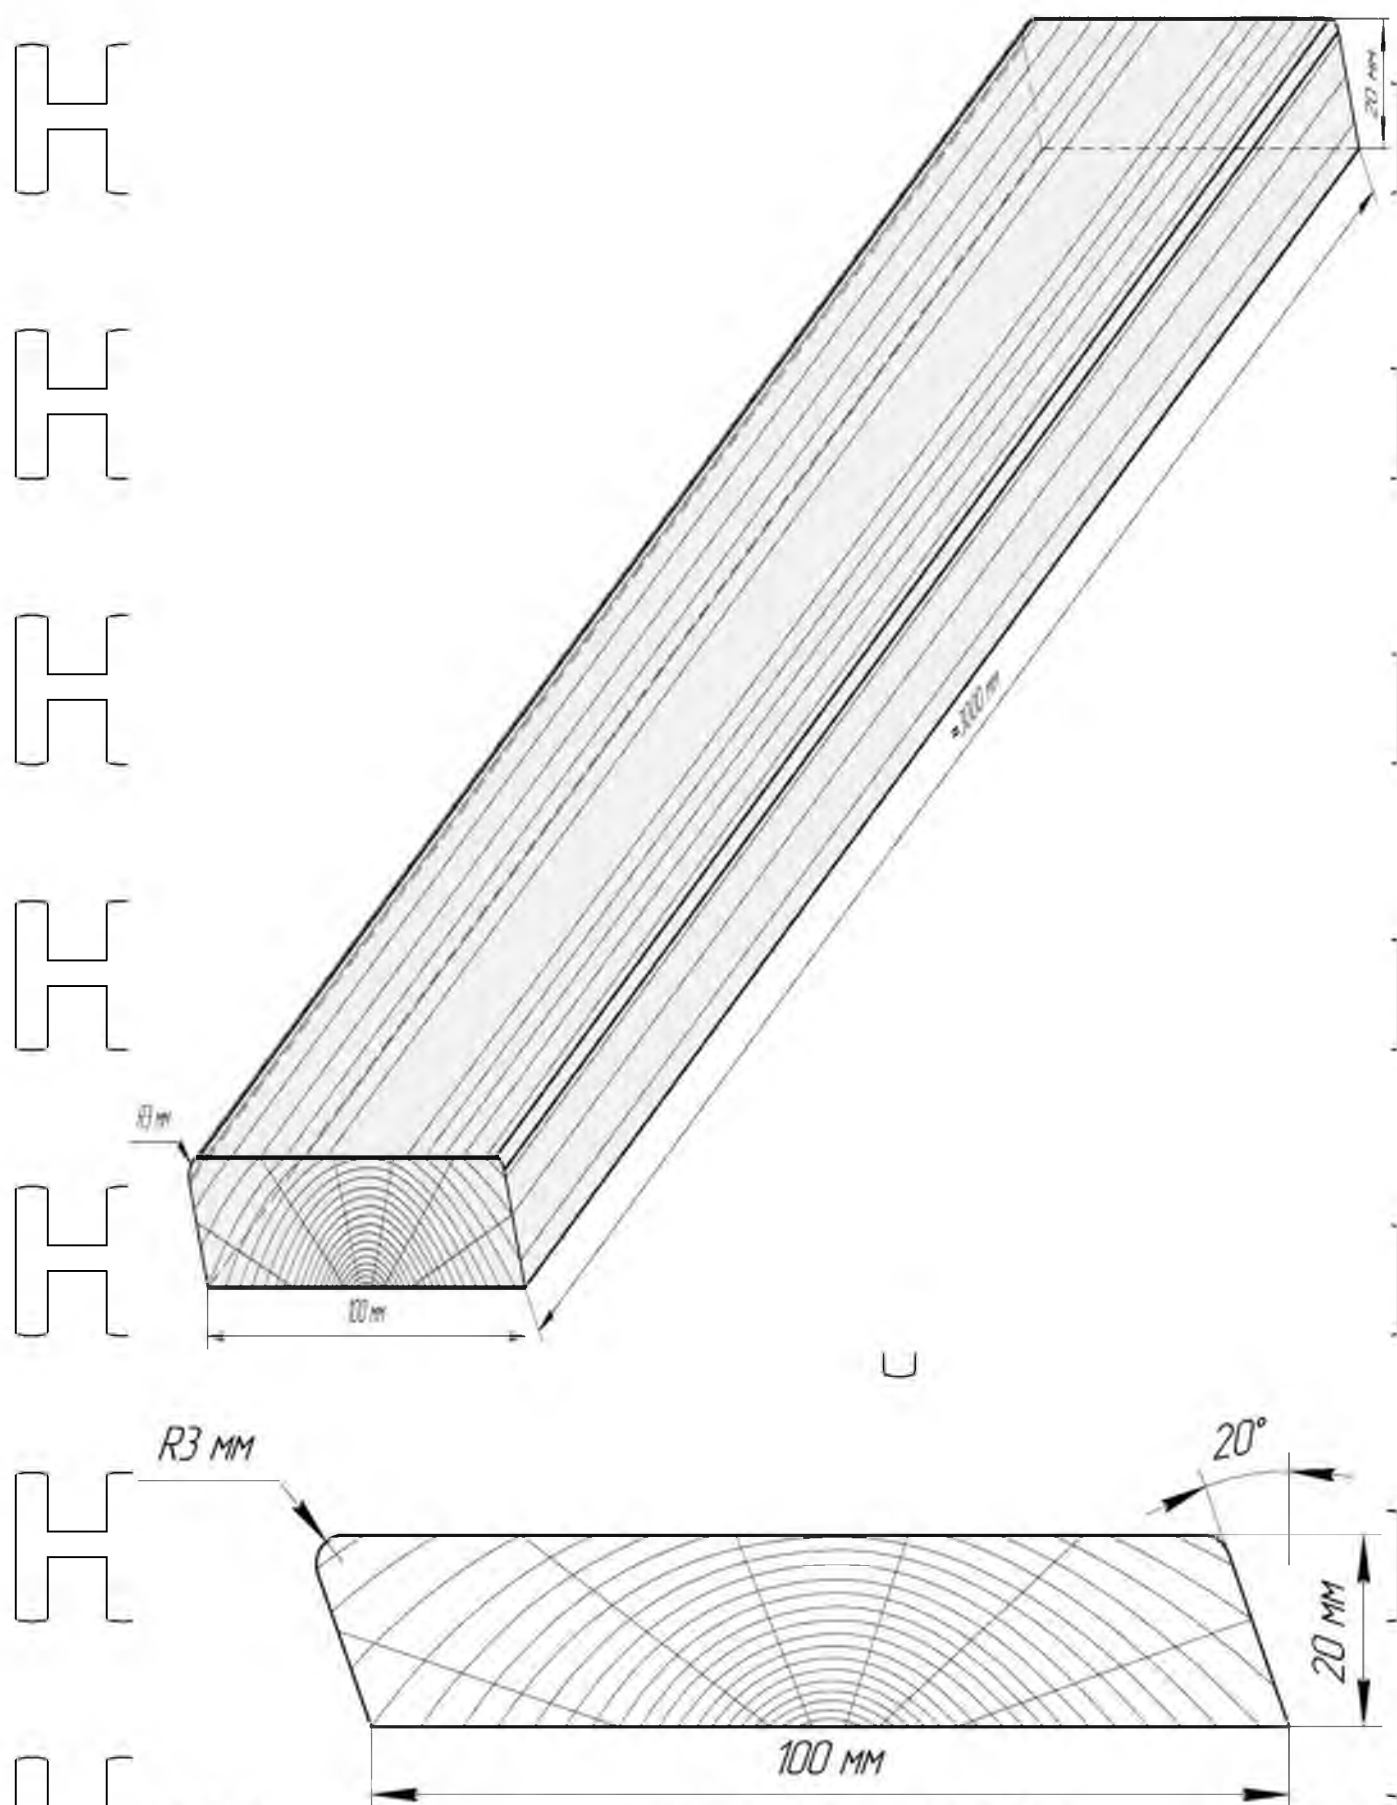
Креслення фасадної дошки для обшиття модульним будинків
